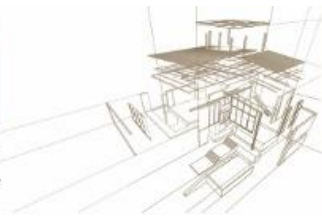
Conectores sistema constructivo Baloon y Plataforma, vista en elevación
